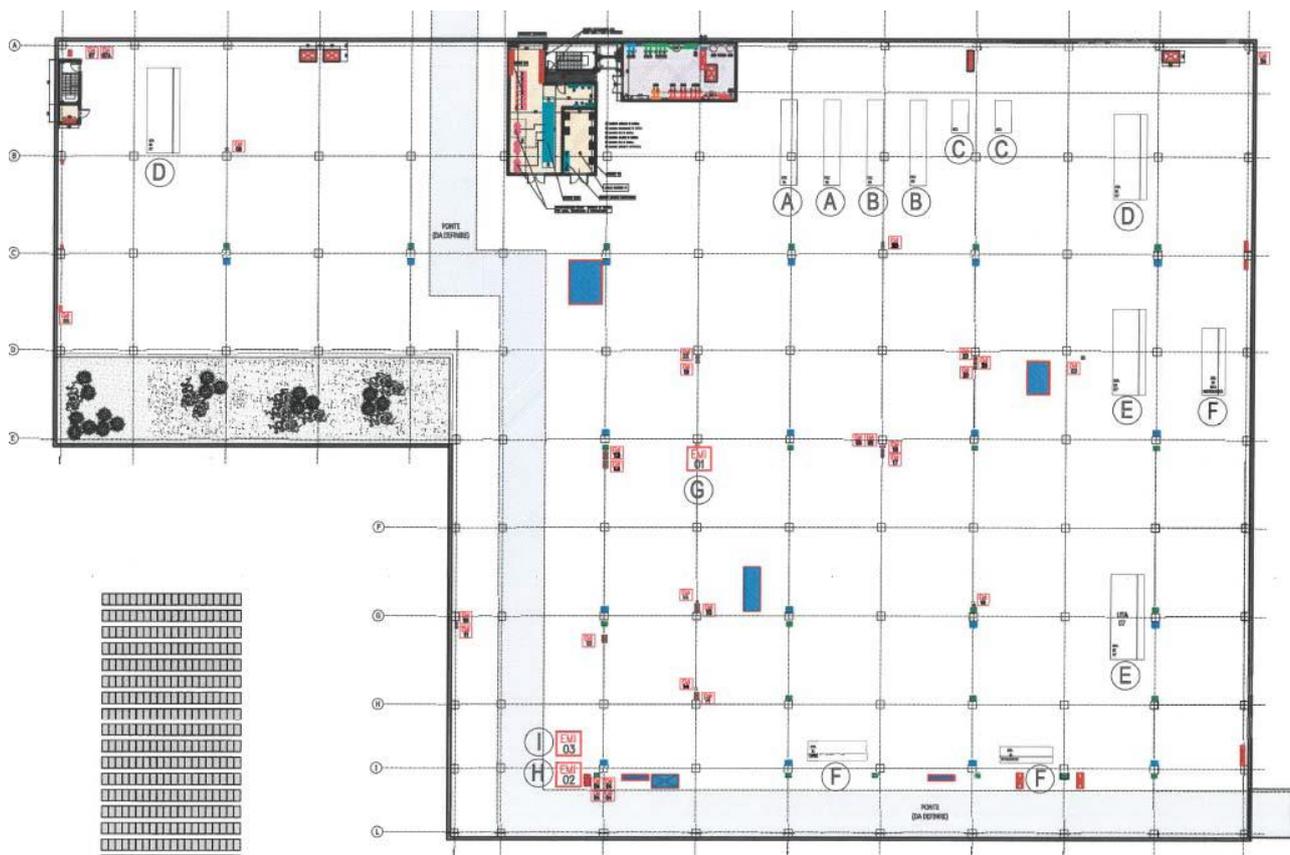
Schema planimetrico con localizzazione delle sorgenti sonore in copertura e-building
